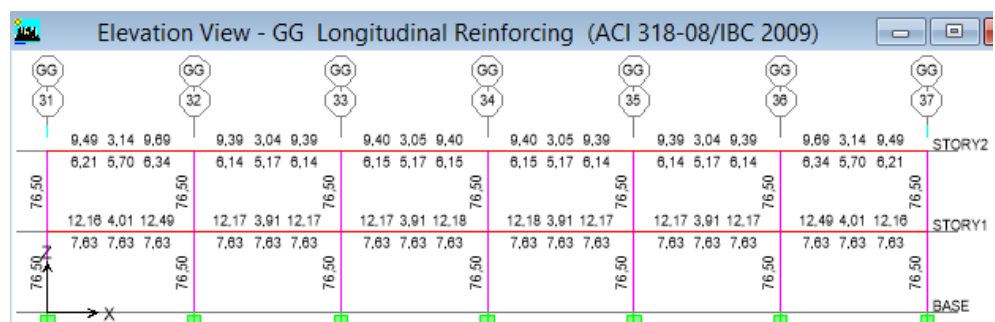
Acero en Vigas y Columnas en el Pórtico GG – Obstetricia- (CEC2002)
